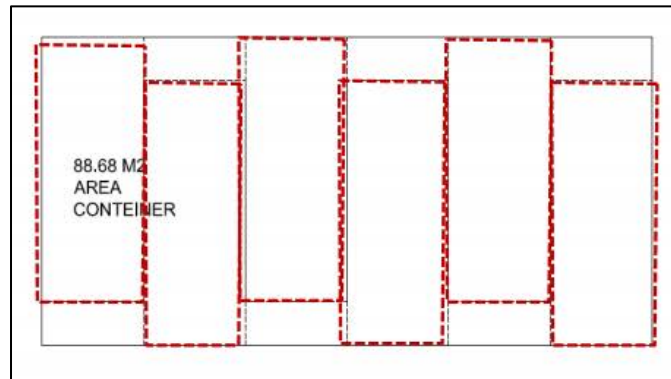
Plano de distribución de contenedores diseño planta de proceso conserva
